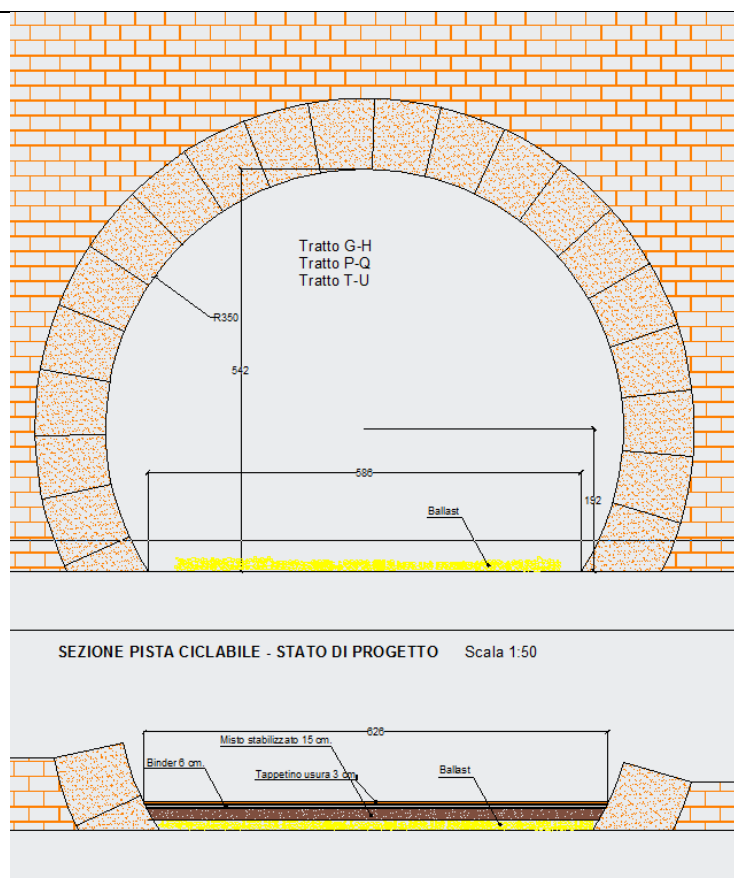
Sezione rappresentativa dello stato di fatto e di progetto della sede stradale
